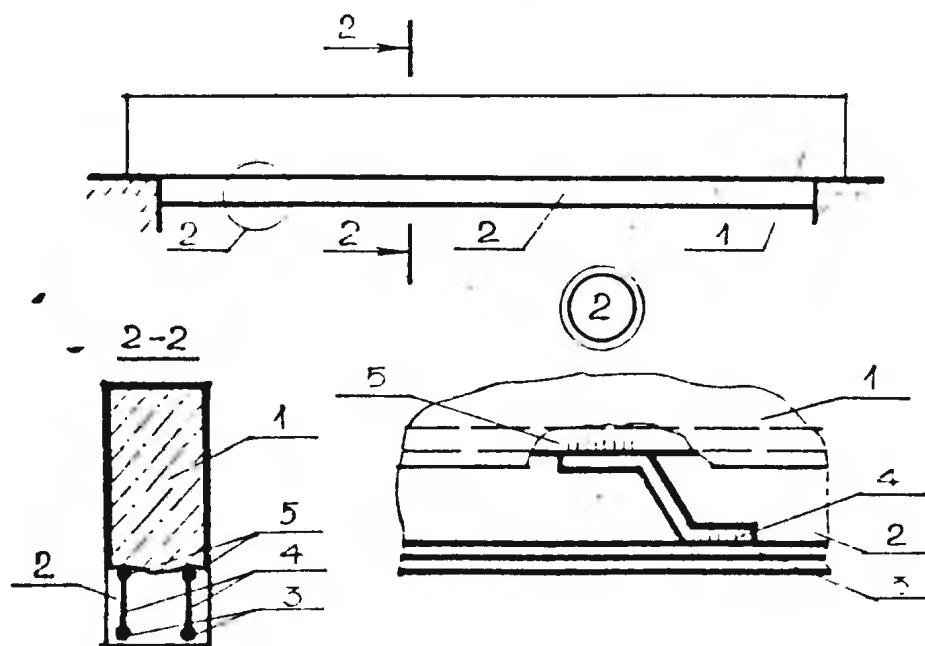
Нарощування балок знизу при значному збільшенні їхньої несучої здатності: 1 – посилювана балка; 2 – залізобетонне нарощування; 3 – поздовжня арматура посилення; 4 – арматурні відгини; 5 – оголена арматура (ділянки із кроком через 1,0 м)
